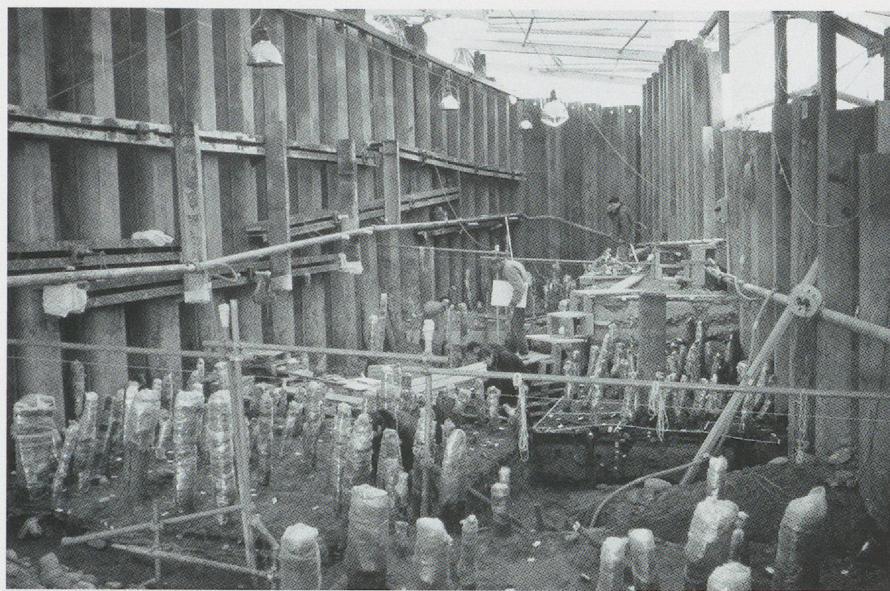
Caisson ouest de la zone 2, vue en direction de l'ouest en mai 1997. Au premier plan, le secteur 130 est en train d'être documenté. A l'arrière, les secteurs 139 et 132 sont en cours de décapage. Cette zone est protégée par une tente qui autorise une avance régulière des travaux, même les jours de mauvais temps, bien qu'on se trouve dans une zone où la sédimentation est peu importante.
